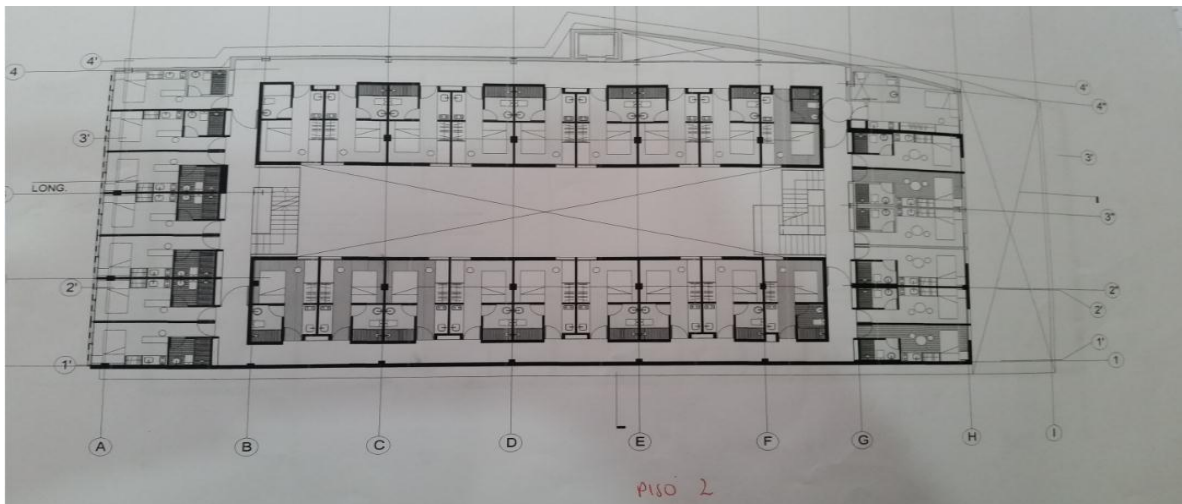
PLANO ARQUITECTÓNICO DEFINITIVO – AP 01bind IMPRESO.
